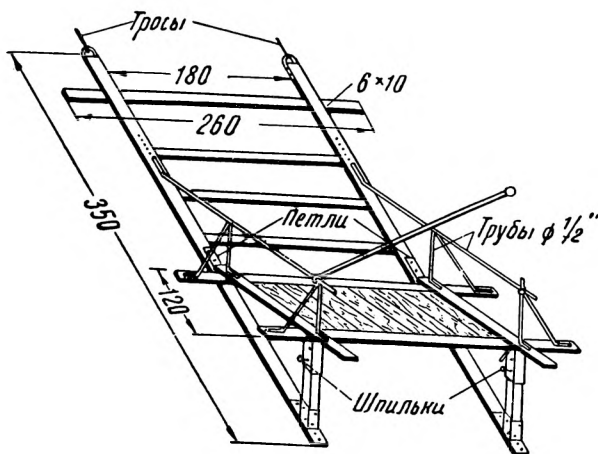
Сборно-разборная площадка для размещения заготовленных частей крыши
